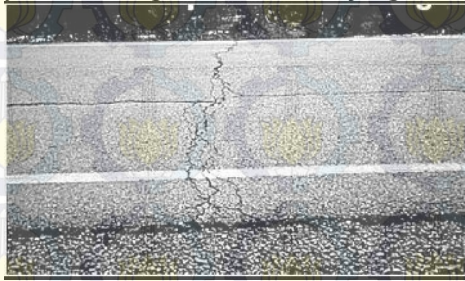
8 Retak memanjang (longitudinal cracks)
